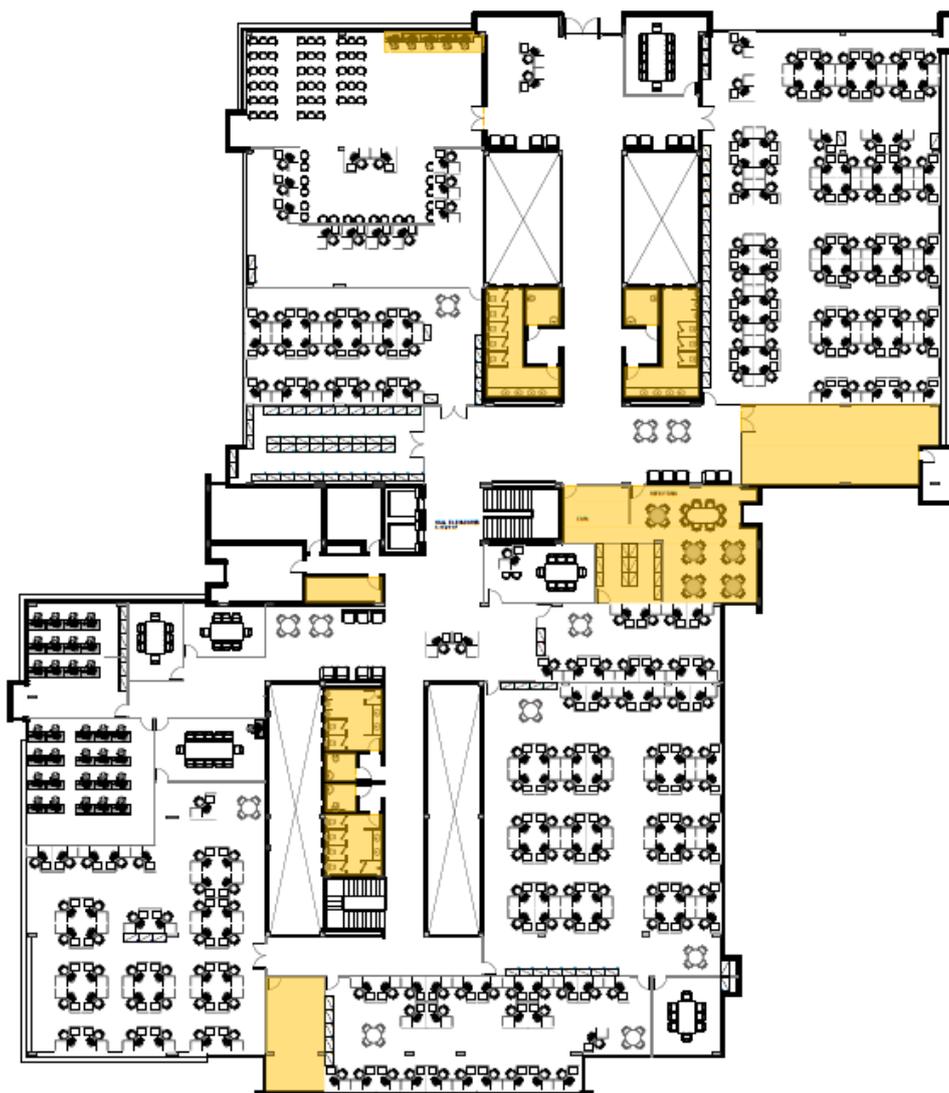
Conjunto de Áreas de Apoio destacadas em laranja.
